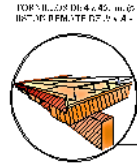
IMAGEN. Detalle del Sistema Estructural y de aislamiento para Entrepiso en Nave de Cocción.
